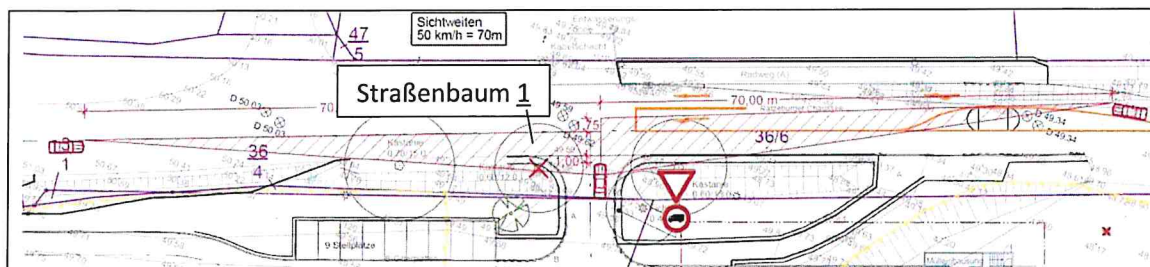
Einzelbäume Straße Rodung, Quelle Auszug Lageplan Sichtweiten iBl Schwerin 06/22
